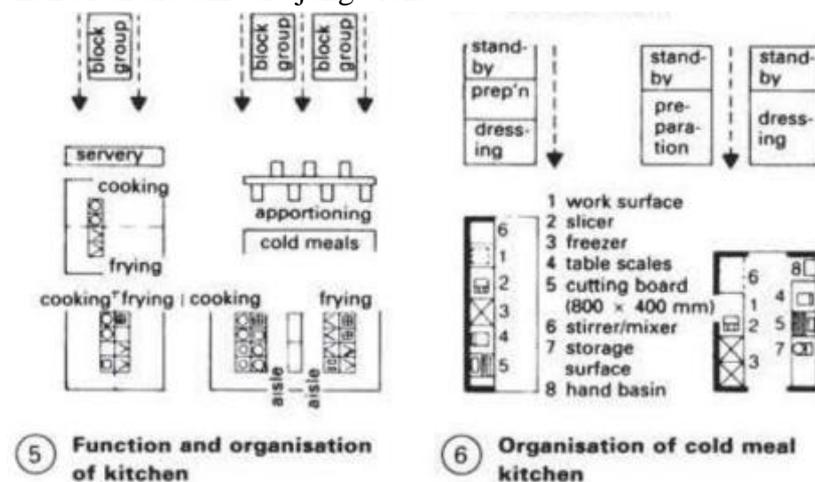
Layout Dapur Berdasarkan Jumlah Tempat Duduk
